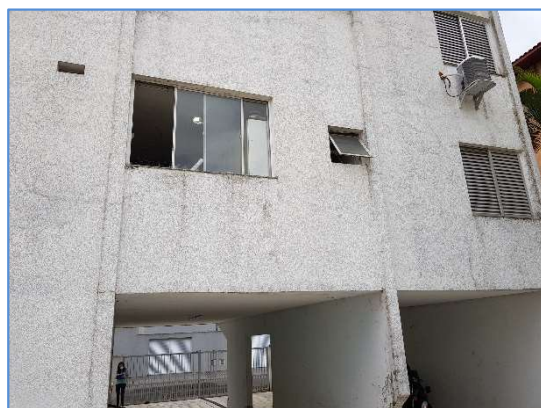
Vista da fachada de fundos do Edifício Hortênsias, com destaque a janela da área de serviço, quarto e banheiro do imóvel avaliando
